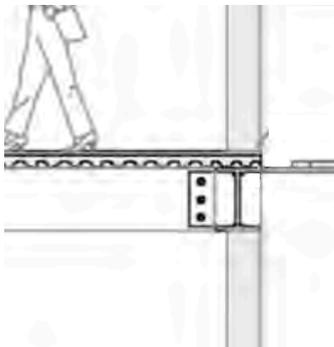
Detalle del corte por fachada. Elaboración propia.
